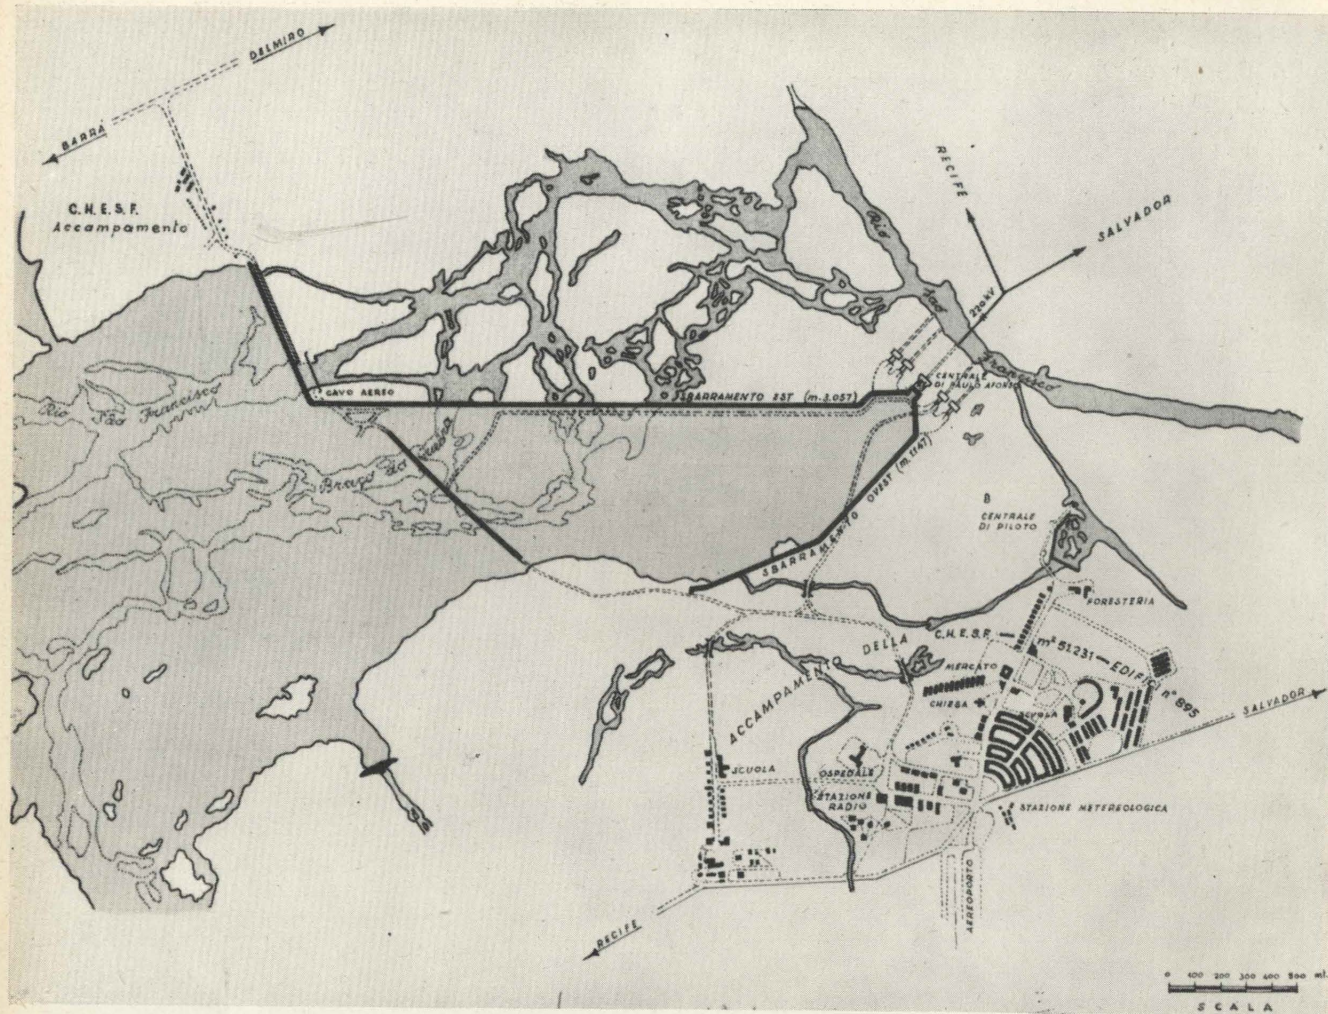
Planimetria generale dell'impianto idroelettrico di Paulo Afonso.
